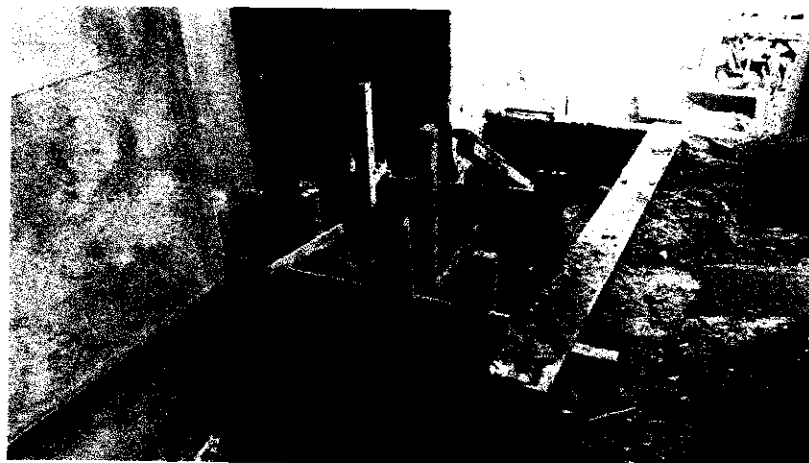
Elaboración de cajas de instalaciones eléctricas.
